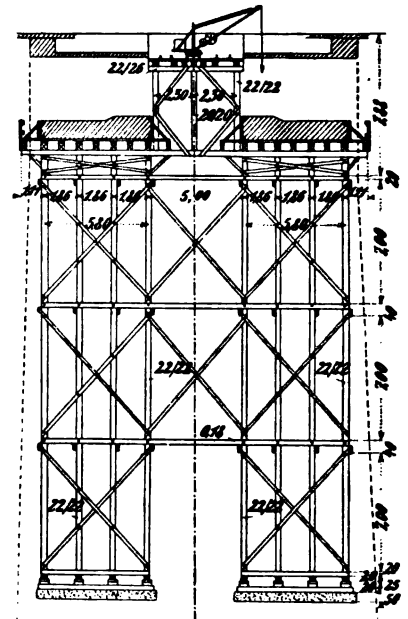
Krangerüst des Viaduktes Chauderon-Montbenon.
